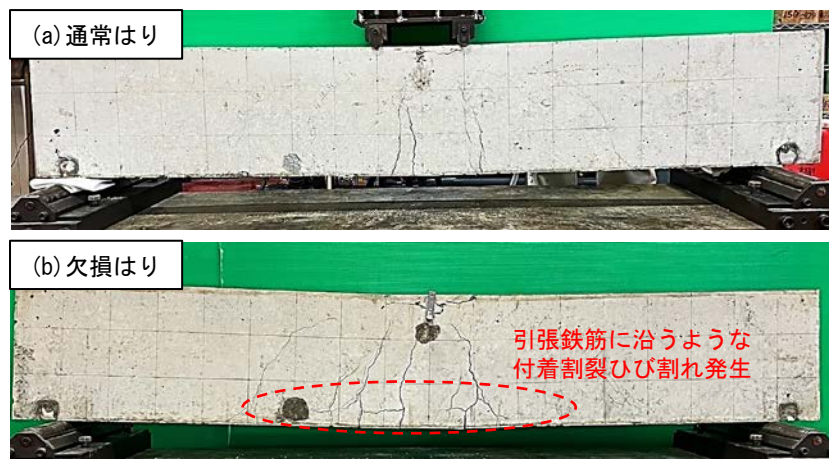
RC はり供試体の曲げ試験後の変形・ひび割れ状況
